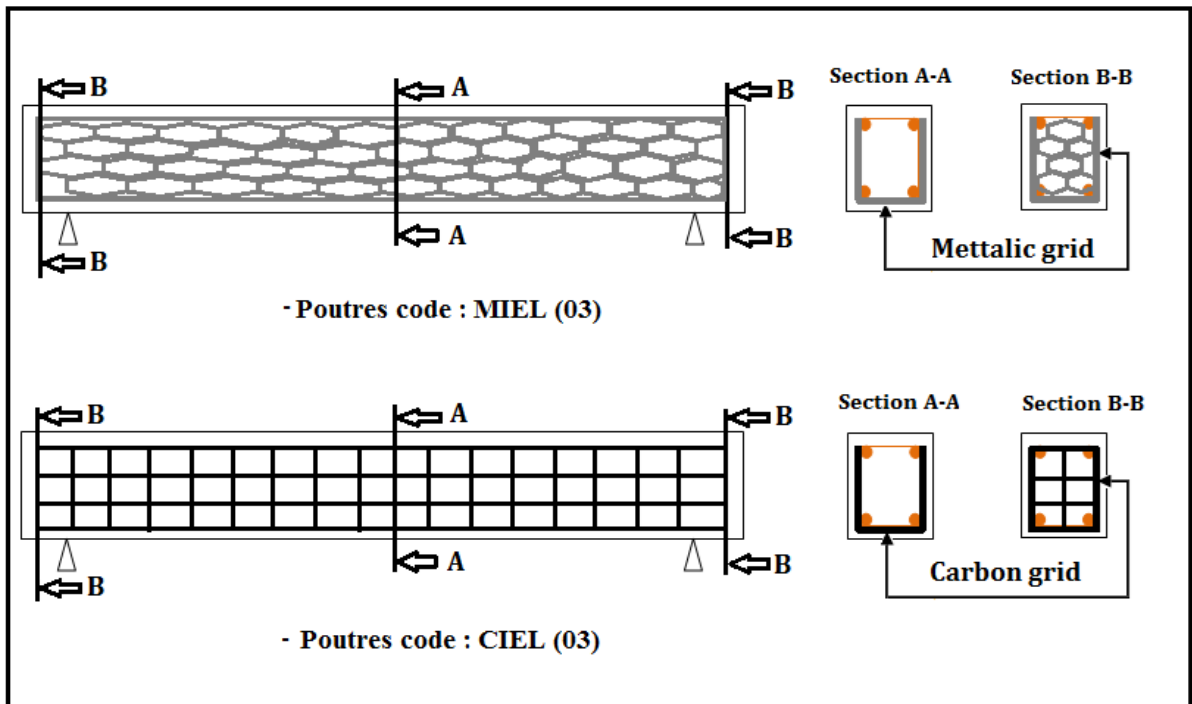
c : Détails de renforcement des poutres du groupe 03.
